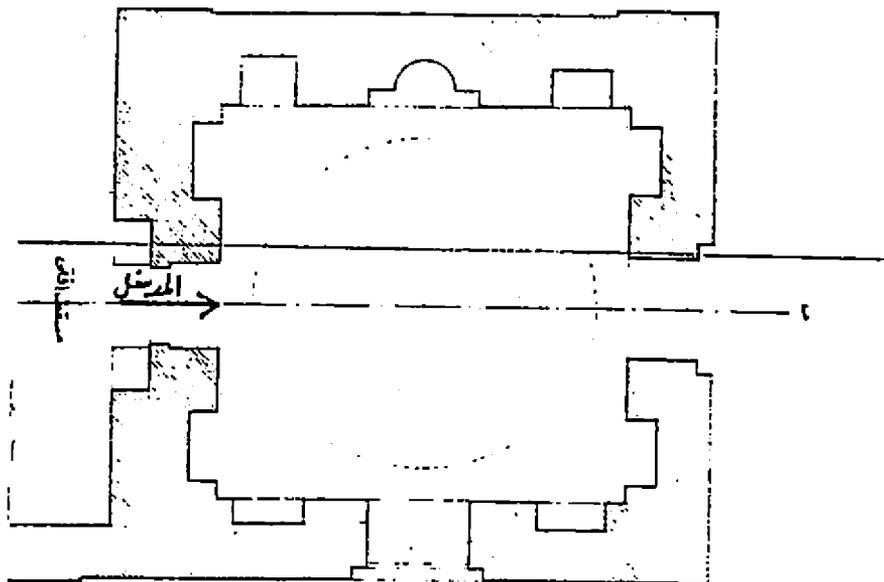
مكرر) مسقط أفقي مقترح لجامع و خانقاه قوصون بقرافة السيوطي
